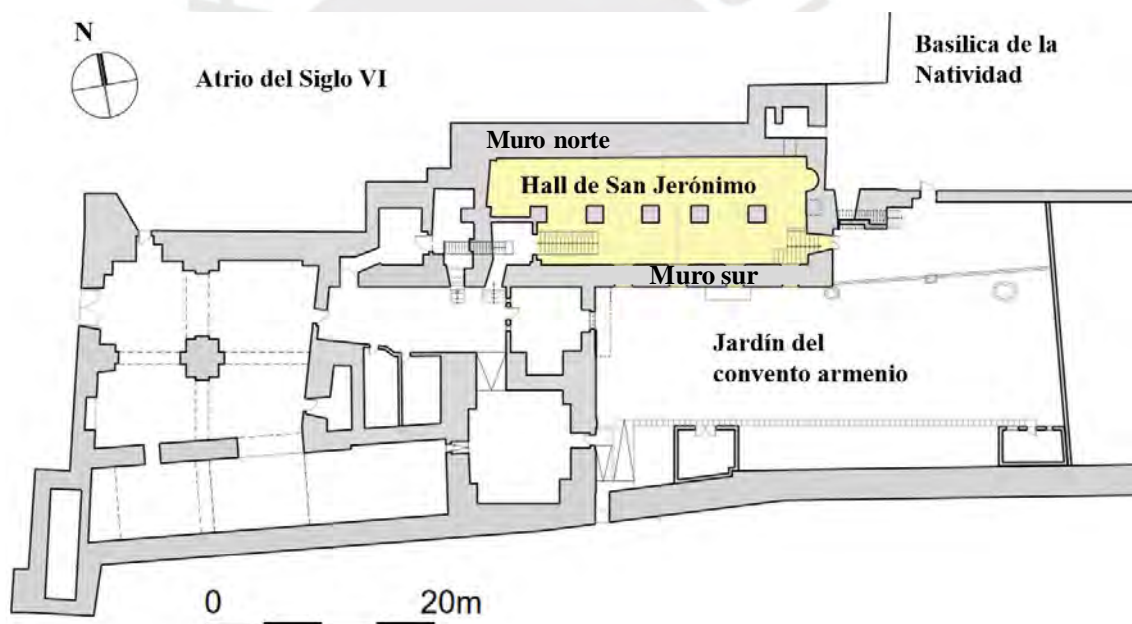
Planta del convento armenio, adaptado de Pando et al. (2017).
